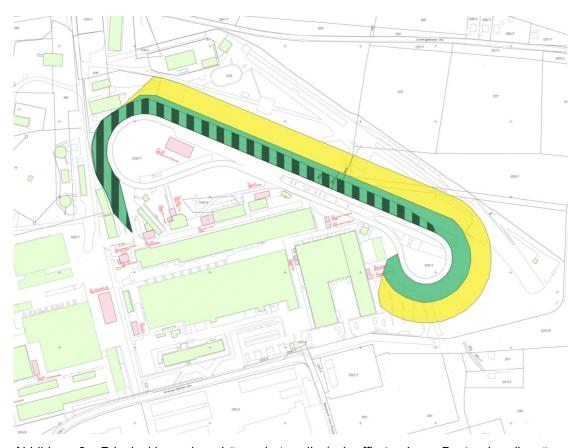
Prinzipskizze eines Lärmschutzwalls (schraffiert = Lage Bestandswall, grün = Wall mit Böschungsbreite von 25 m, gelb = Wall mit Böschungsbreite von 54 m), eigene Darstellugn auf Grundlage von [21].
